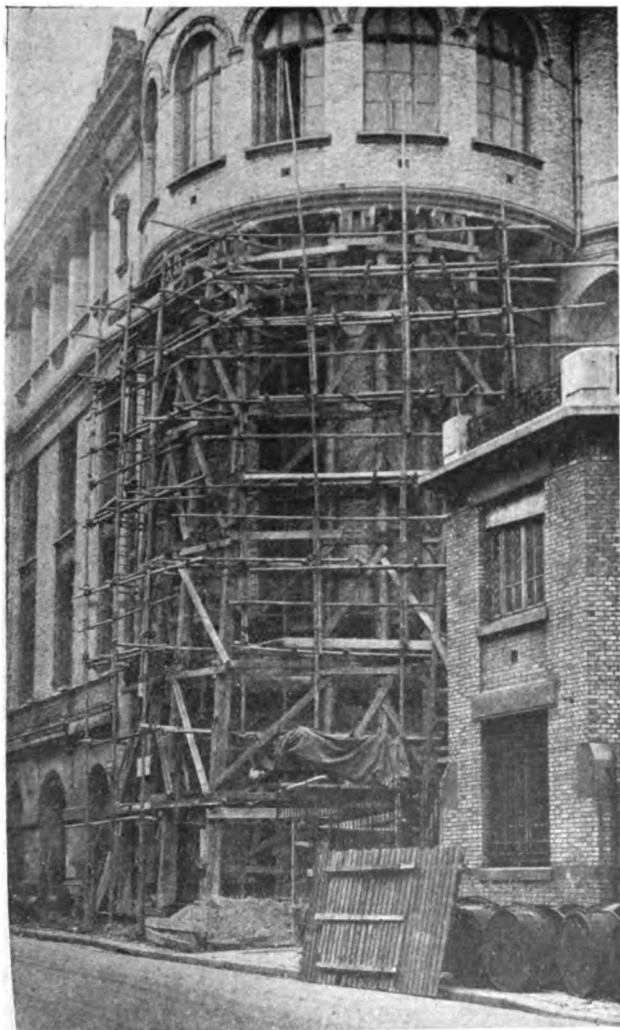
Reprise en sous-œuvre et soutènement de la façade du central « Gutenberg » pour la pénétration d'une galerie.
